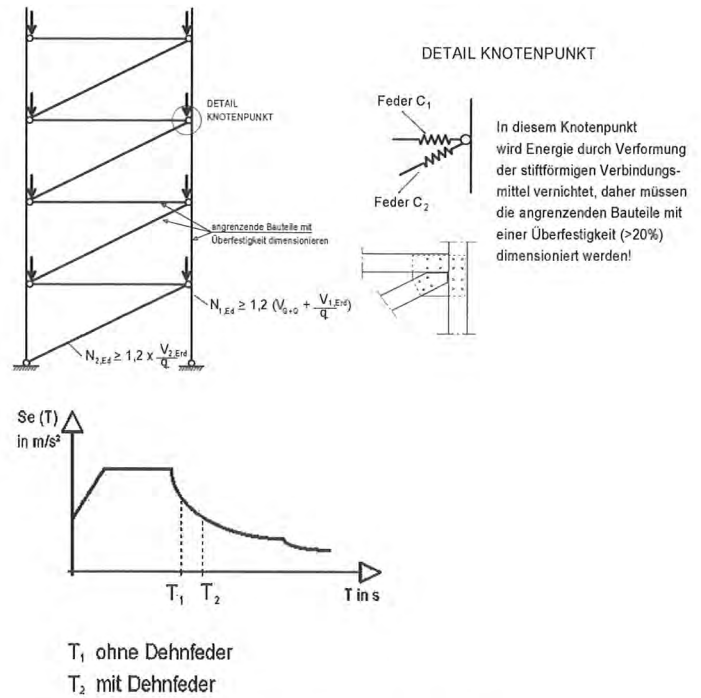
Beispiel einer mehrgeschossigen Aussichtsplattform
